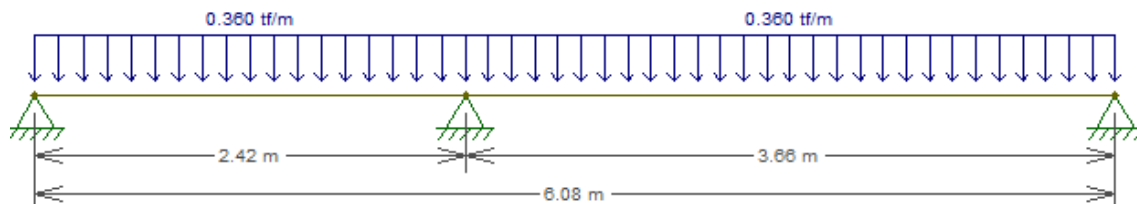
Distribución de cargas últimas de la losa aligerada
